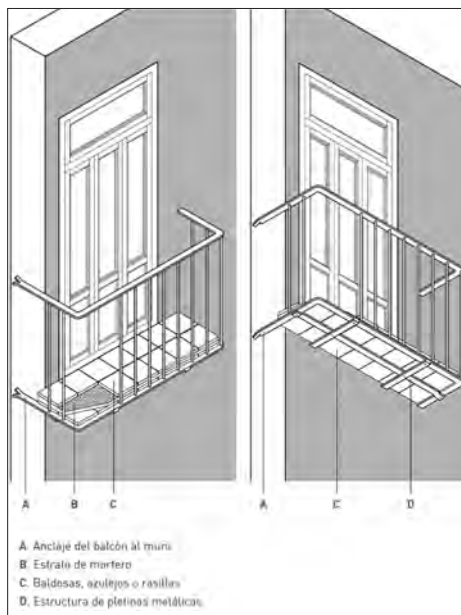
Esempi di balconi con struttura metallica: restituzione grafica (A. Collegamento del balcone con la muratura, B. Massetto di calce, C. Mattonelle ceramiche o piastrelle, D. Struttura metallica).
